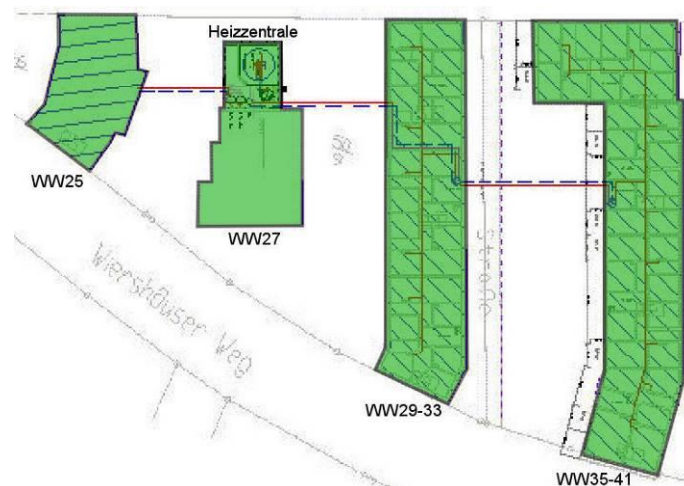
Lageplan der Gebäude (Mehrfamilienhäuser WW 25, WW 29-33, WW 35-41, sowie Verwaltungsbau WW 27)
